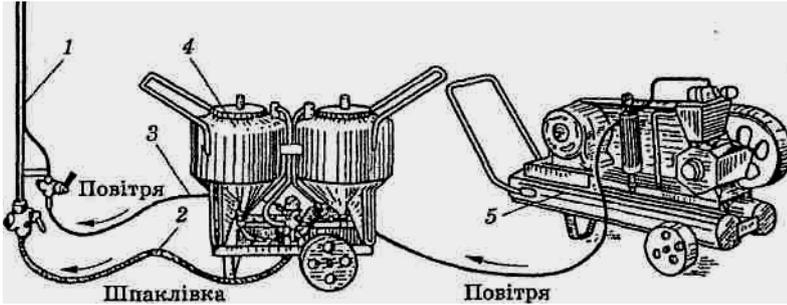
Схема шпаклювального агрегату з установкою СО-21А:
